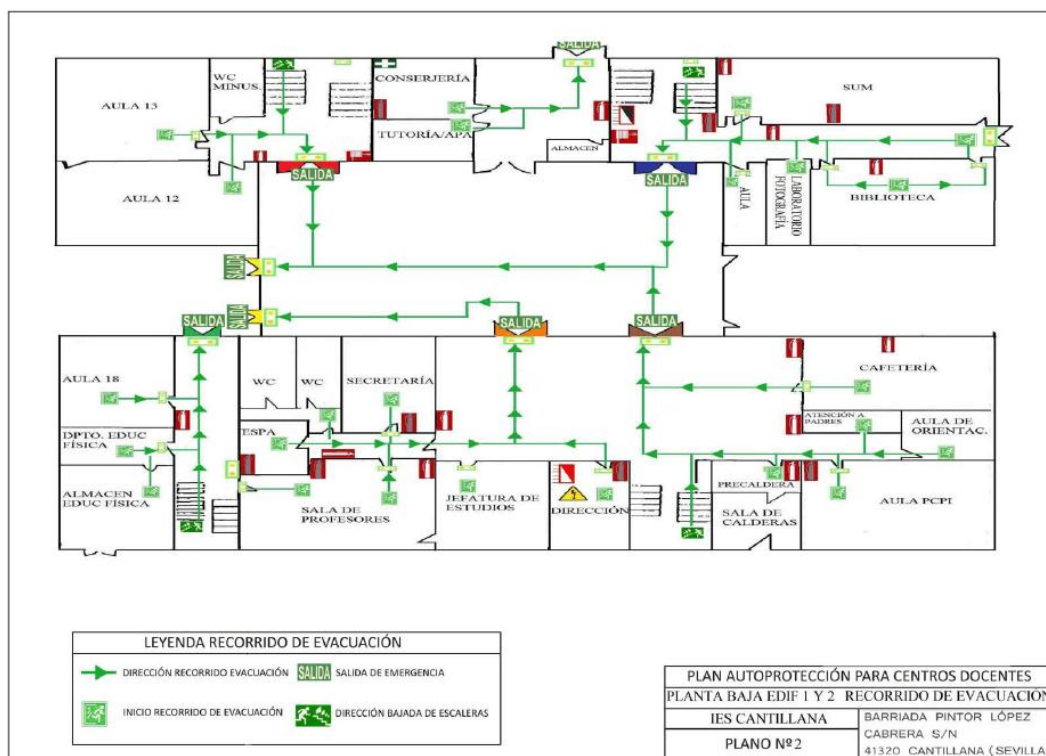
Plano de evacuación en planta baja de los edificios 1 y 2 del IES Cantillana.
